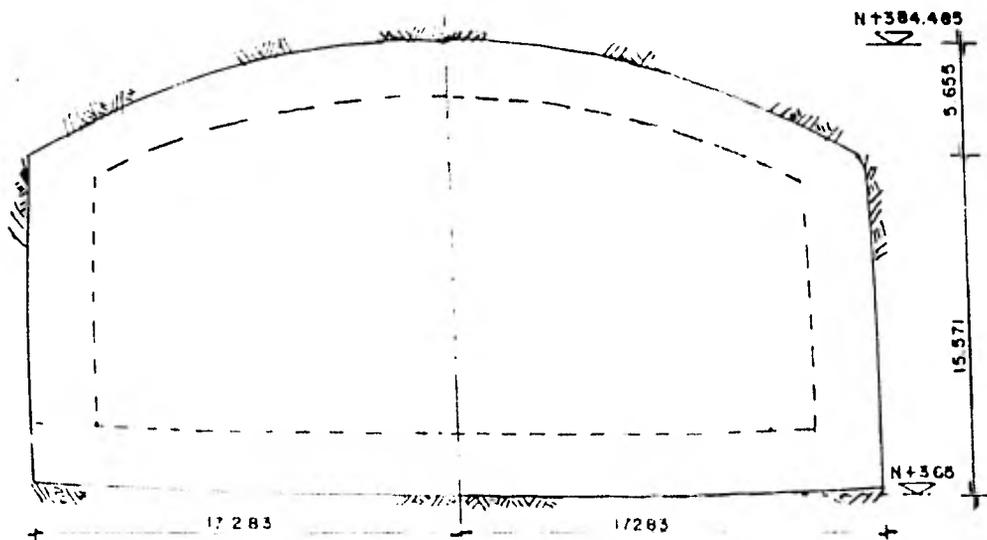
A. SECCION PORTAL CADENAMIENTO 0+046.874
